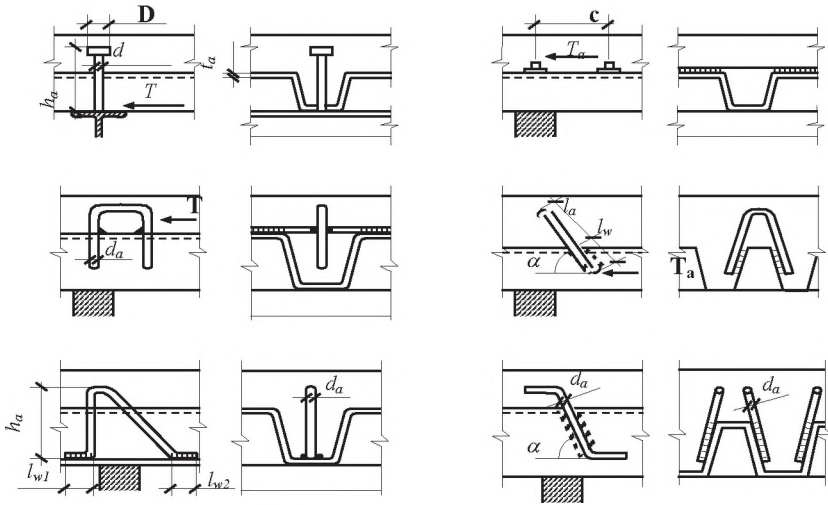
Конструкції анкерів у сталезалізобетонних конструкціях по профільованому настилу
